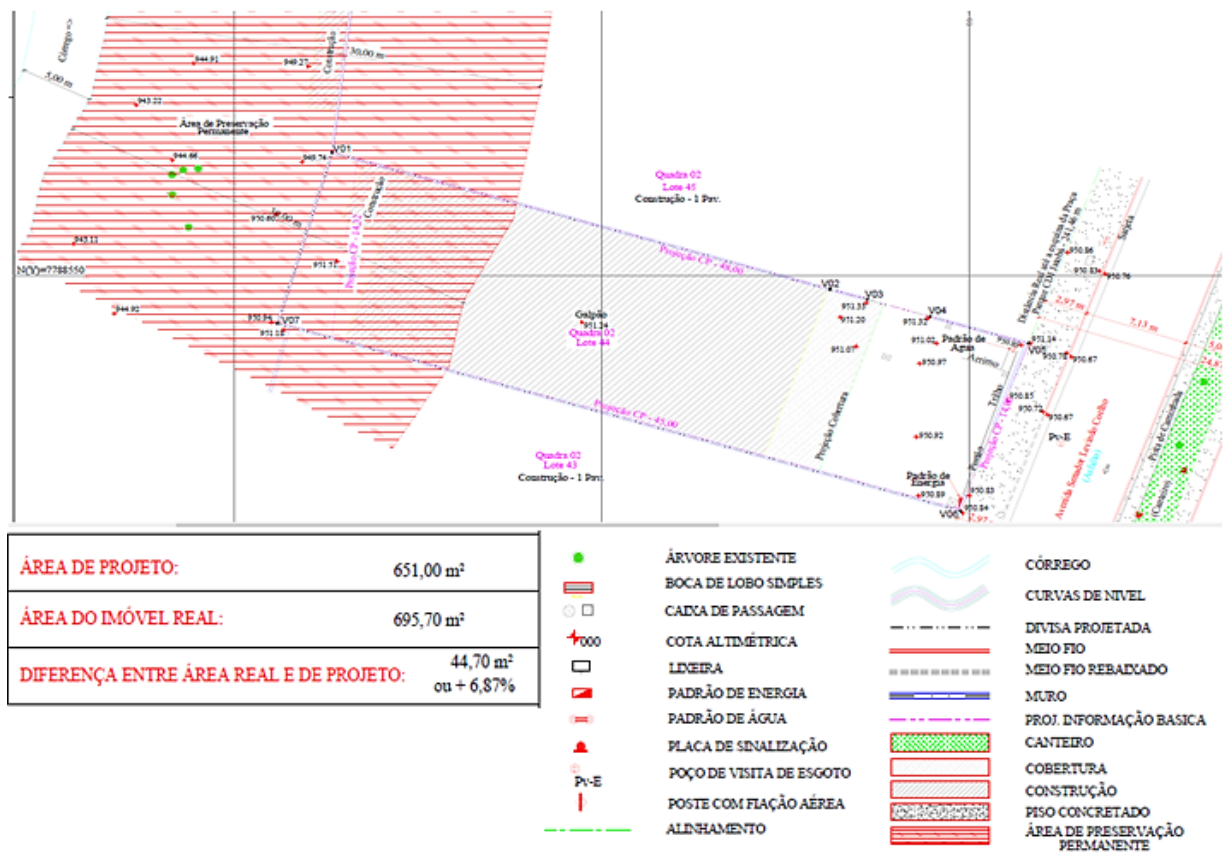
Levantamento Planialtimétrico do Lote 44 – Adaptado do Protocolo nº 07857/23 (Fonte: Requerente).
